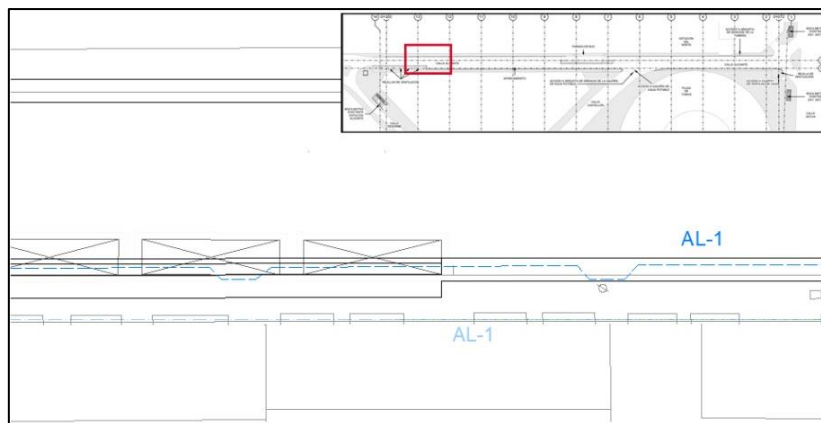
Plano de reposición ALUMB-AL1-SR-CX-F9
